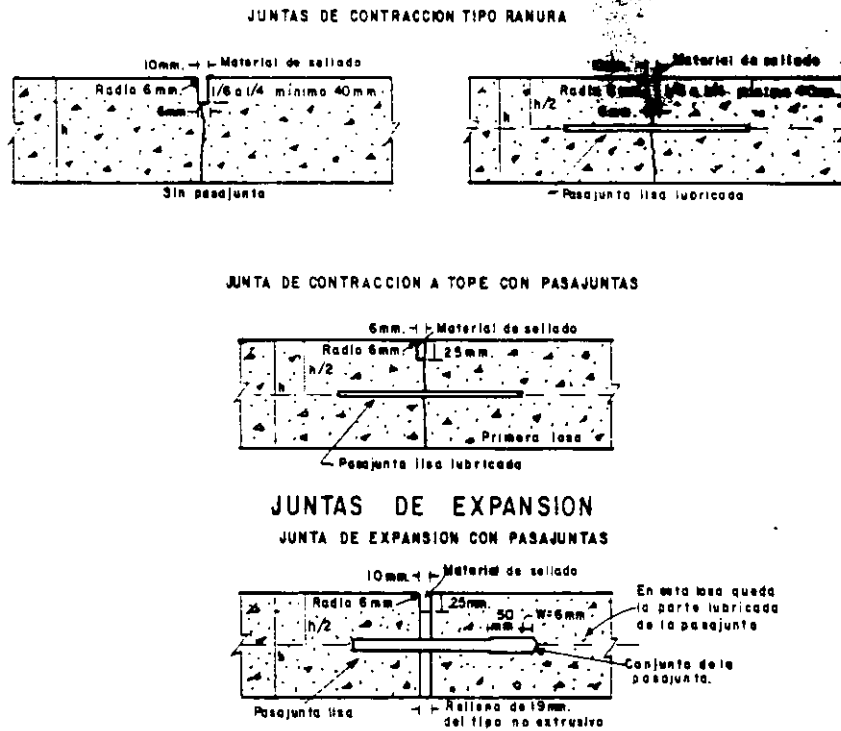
Detalles recomendados de diseño de junta de contracción transversal para carreteras.
